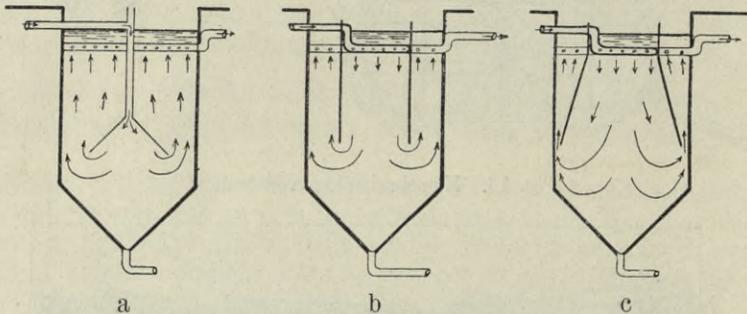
Ausnutzung des Sedimentiererraums bei Klärbrunnen (schematisch).
